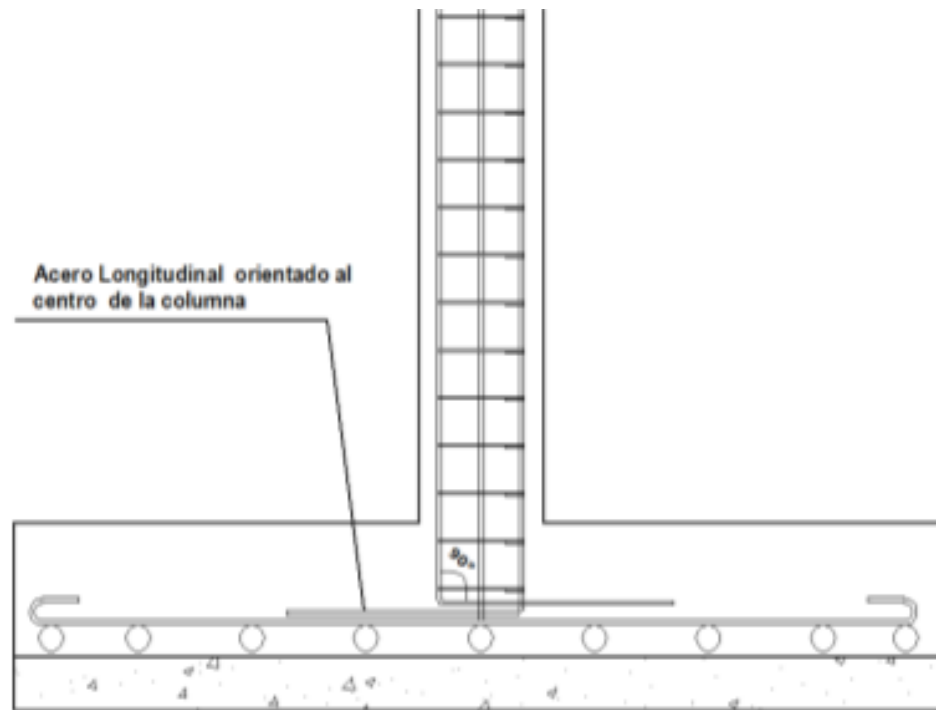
Refuerzo longitudinal que resiste flexión orientado hacia el centro de la columna
